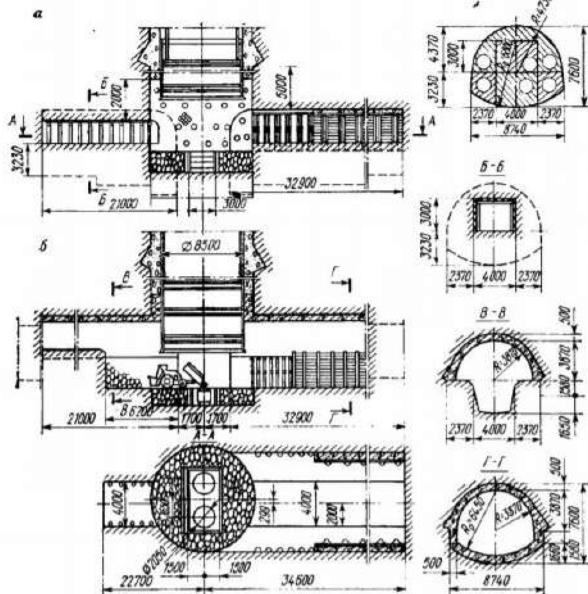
Схема строительства сопряжения ствола с горизонтальной выработкой околоствольного двора слоями сверху вниз с проведением по своду сопряжения предварительной выработки: а – схема рассечки; б – схема производства работ.
